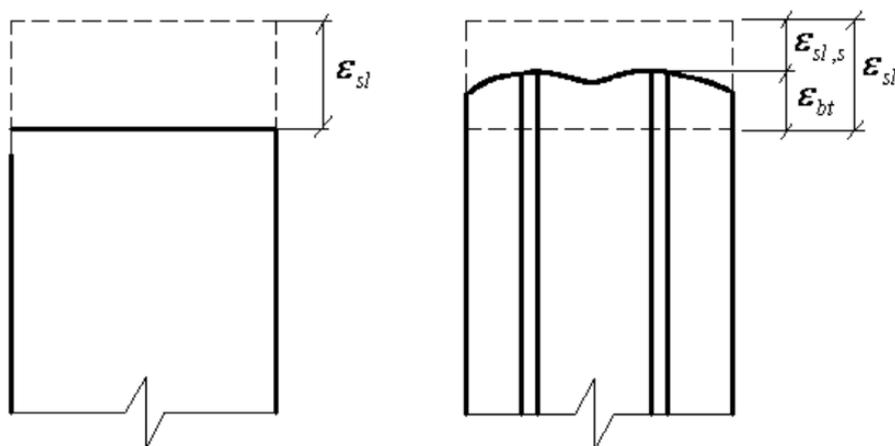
Деформации усадки образцов: а – бетонного; б – железобетонного
